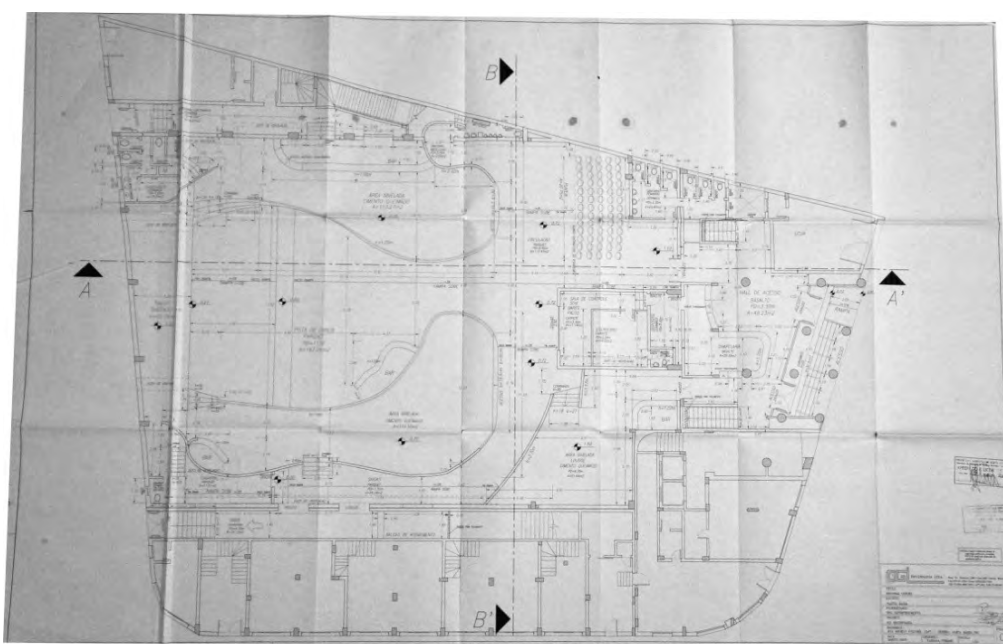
Foto da Planta Baixa da Reforma Boate Cinema
